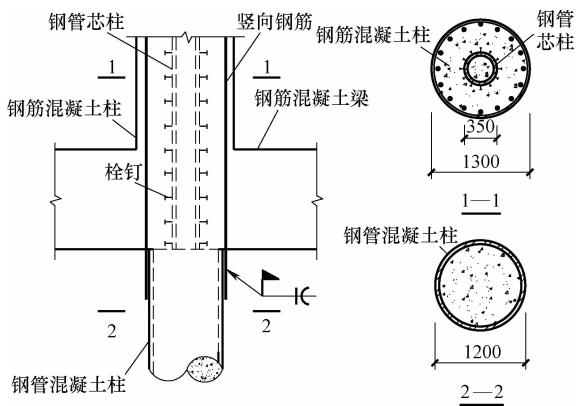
钢管混凝土芯柱与钢管混凝土柱的连接
